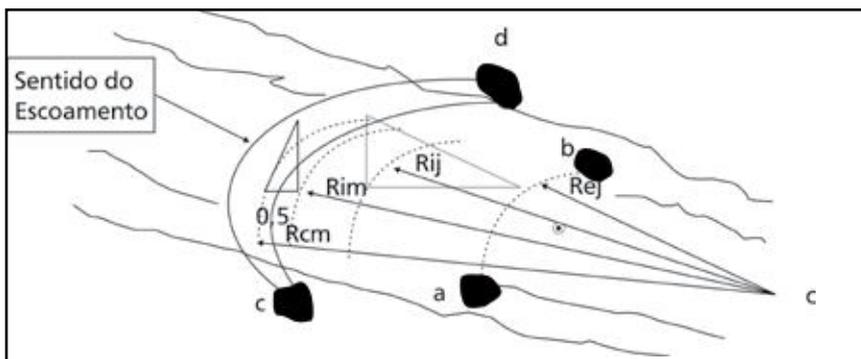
Esquema Demonstrativo das Marcações de uma Barragem de Pedra
